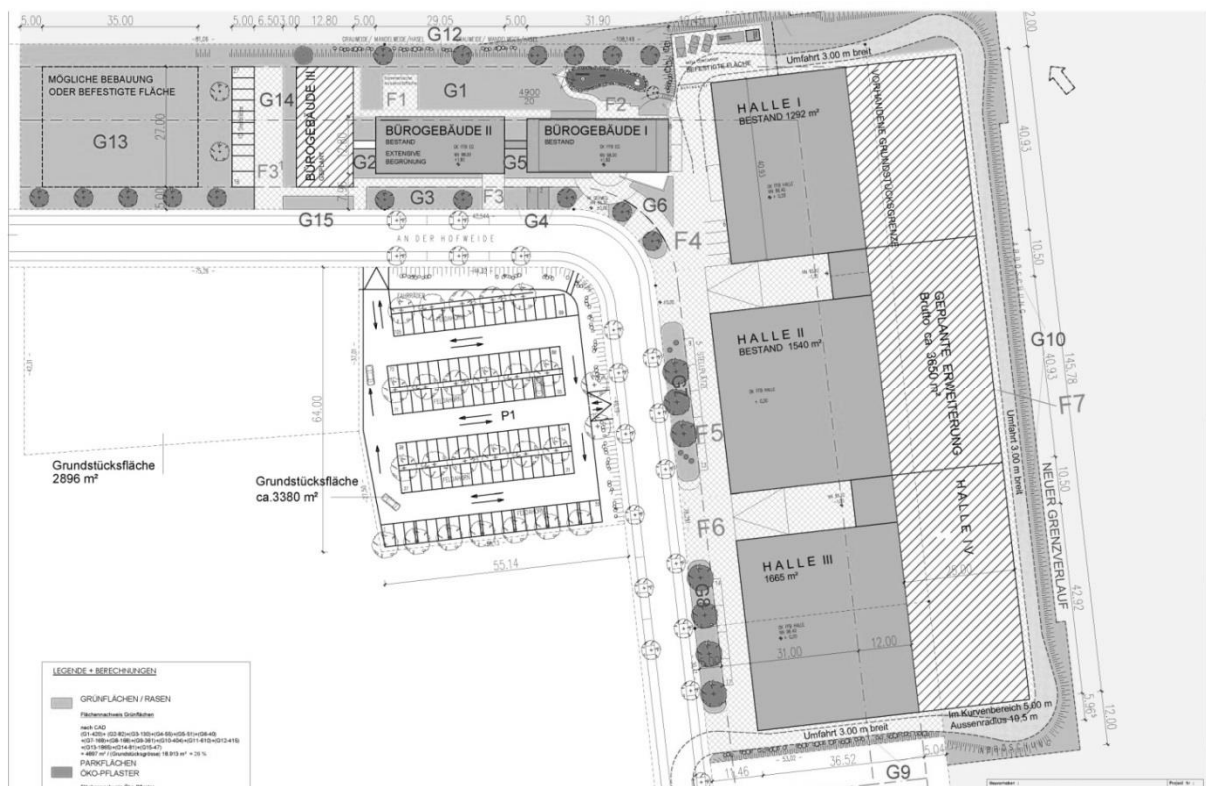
GRUNDRISS GEBÄUDE Lorentz Architekturbüro, 18.02.2017 Schwetzingen, OHNE MAßSTAB
